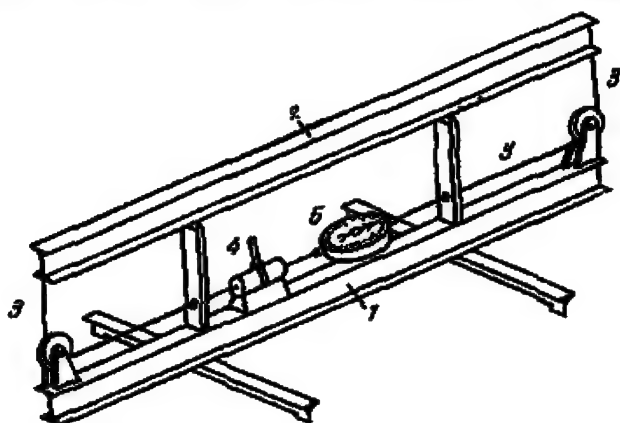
| Instalación de mesa para ensayos a flexión pura de la viga: 1, bancada; 2, viga ensayada; 3, cable; 4, manguito tensor; 5, dinamómetro.
